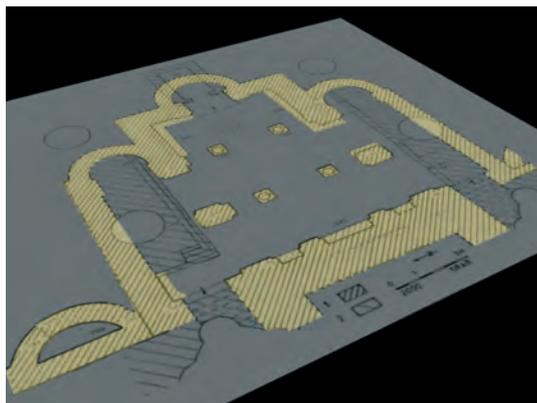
Plan de la crypte et première ébauche de modélisation 3D.
